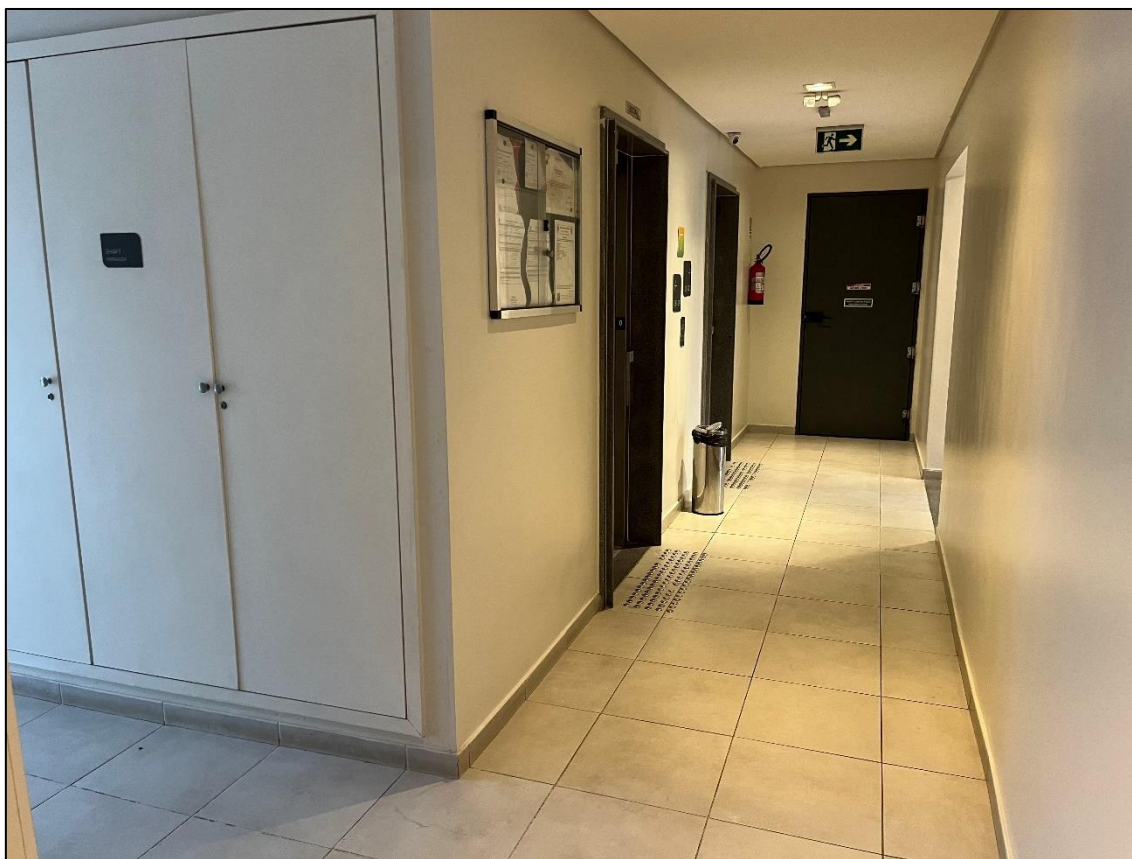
Vista do hall de entrada (térreo) e elevadores (social e serviço).
